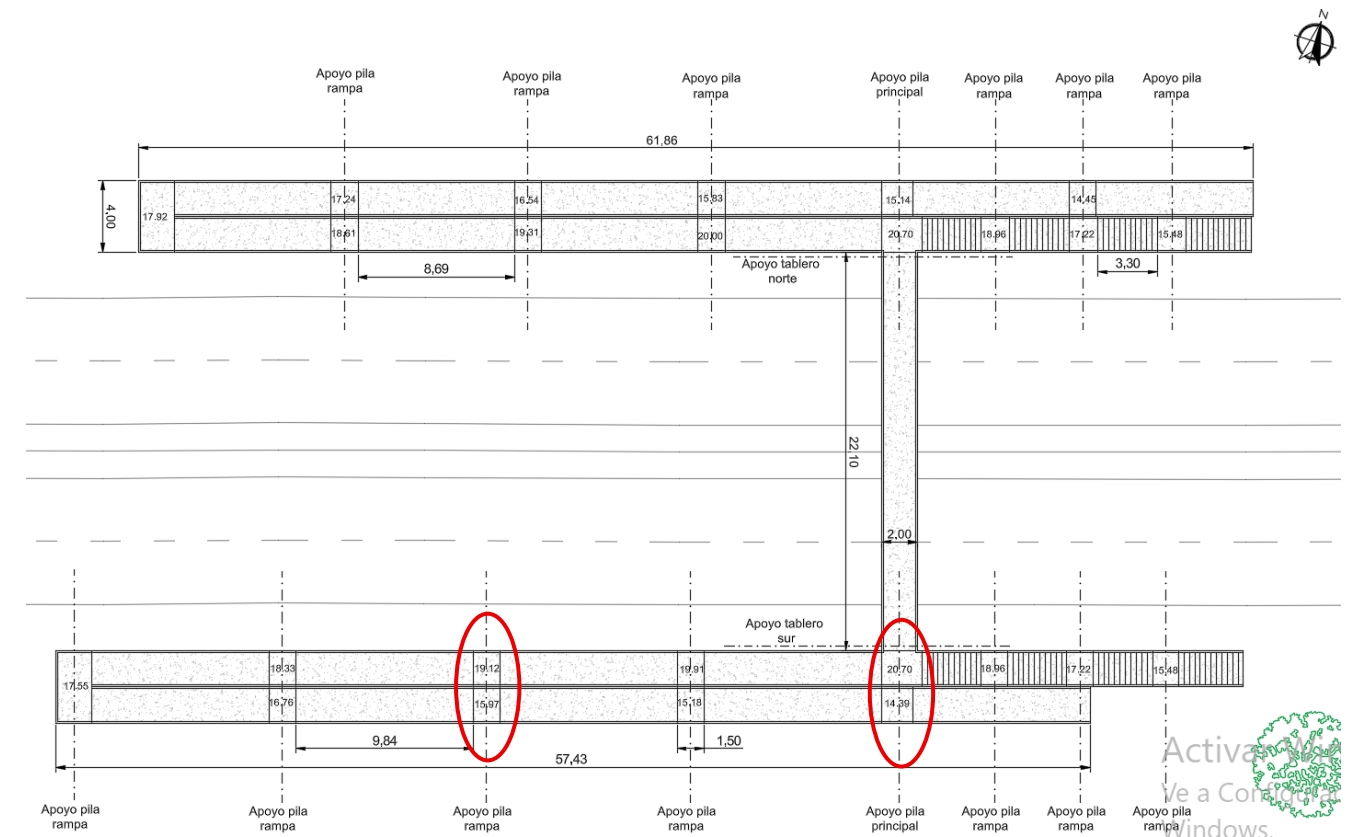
Vista en planta de la ubicación de las zapatas a diseñar. Fuente: Elaboración propia.
